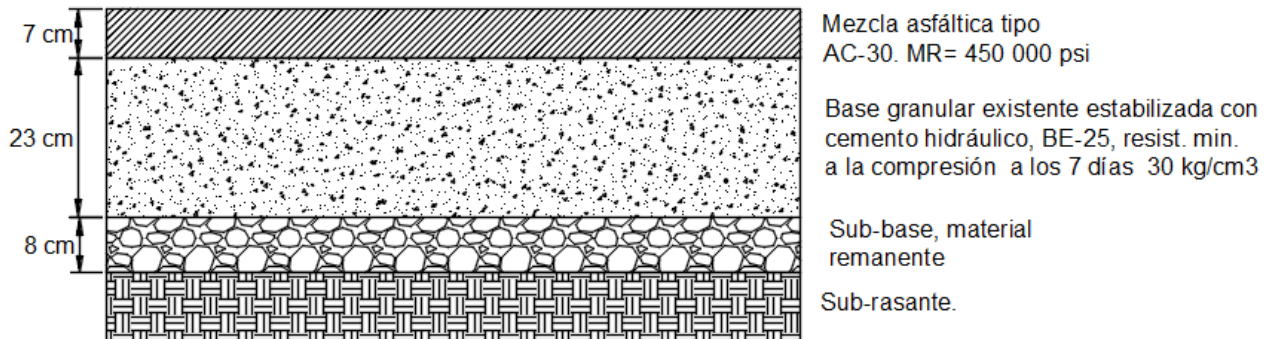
Perfil de la estructura de pavimento propuesta para el TH=31.
